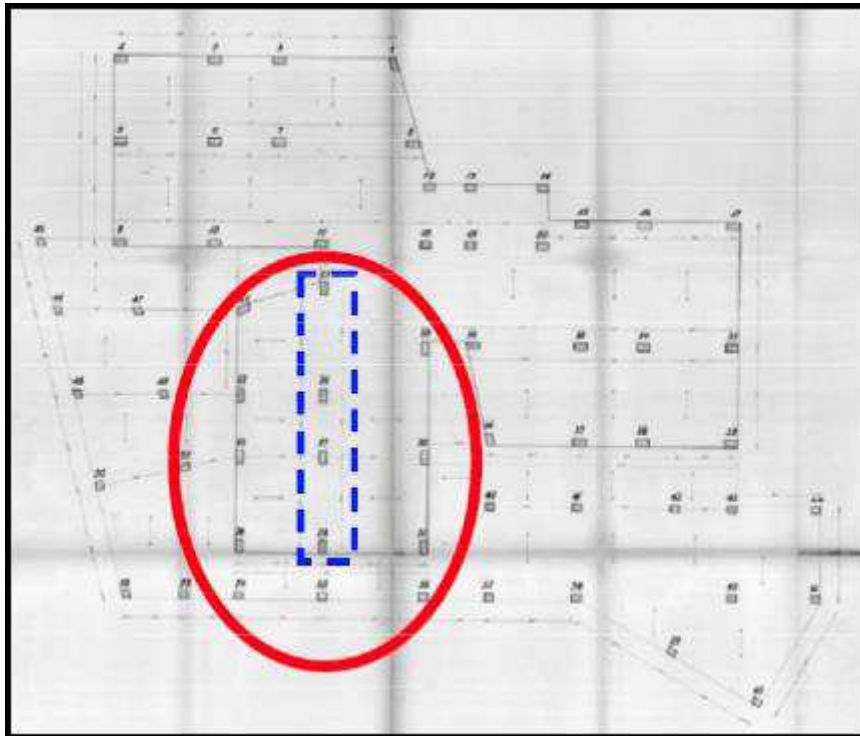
Posizionamento originale dei pilastri Casa dello Studente all'Aquila
